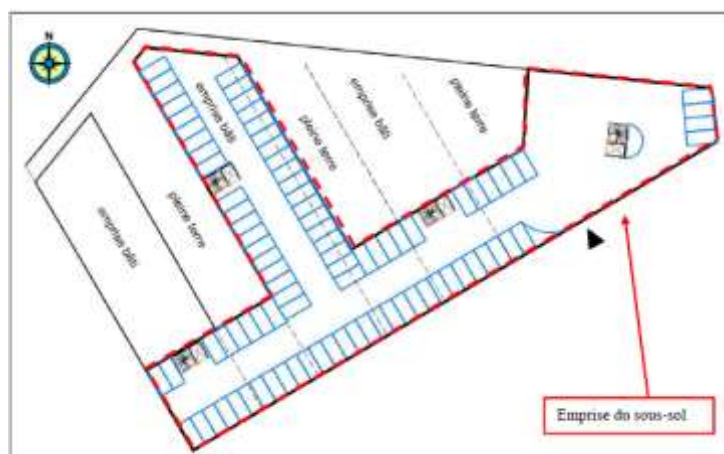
Extrait du plan prévisionnel des parkings - Niveau R-1
